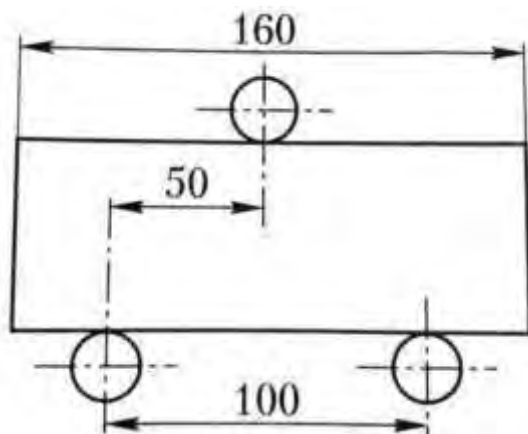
Схема испытания балочки на изгиб: 1 – опоры, 2 – нагружающий валик, 3 – балочка
